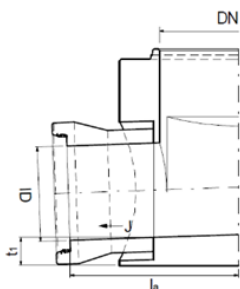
Anschluss mit eingebautem Muffenstück in Schachtwand
